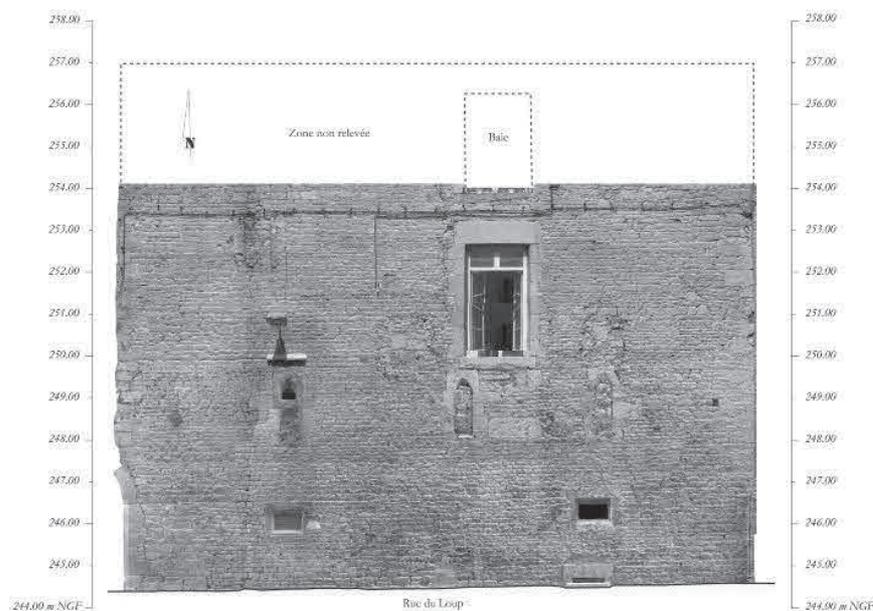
Besançon, rue du Loup, façade, relevé par assemblage de photographies redressées (M.-L. Bassi).
